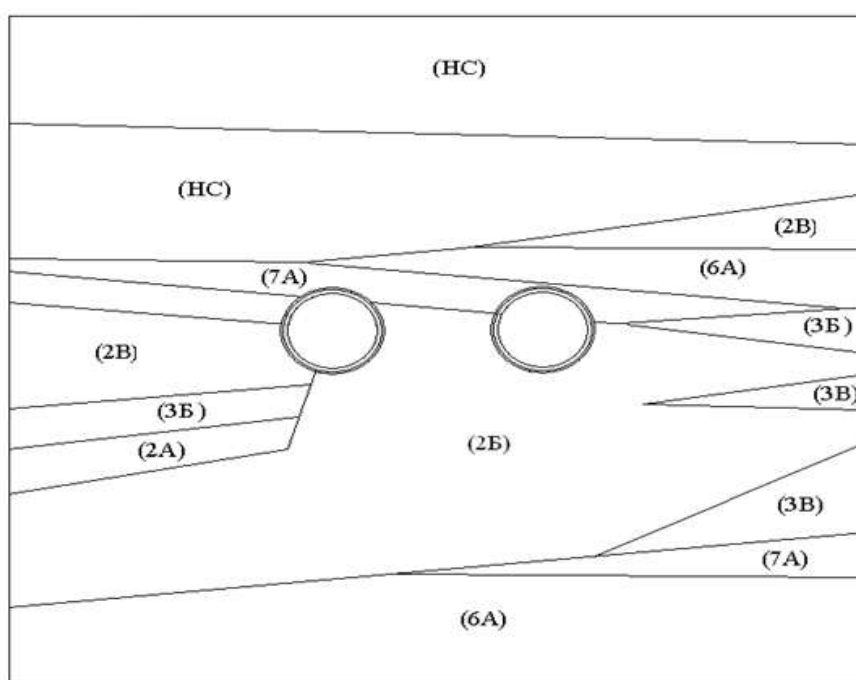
Разрез грунтов в зоне прокладки тоннелей метрополитена.
